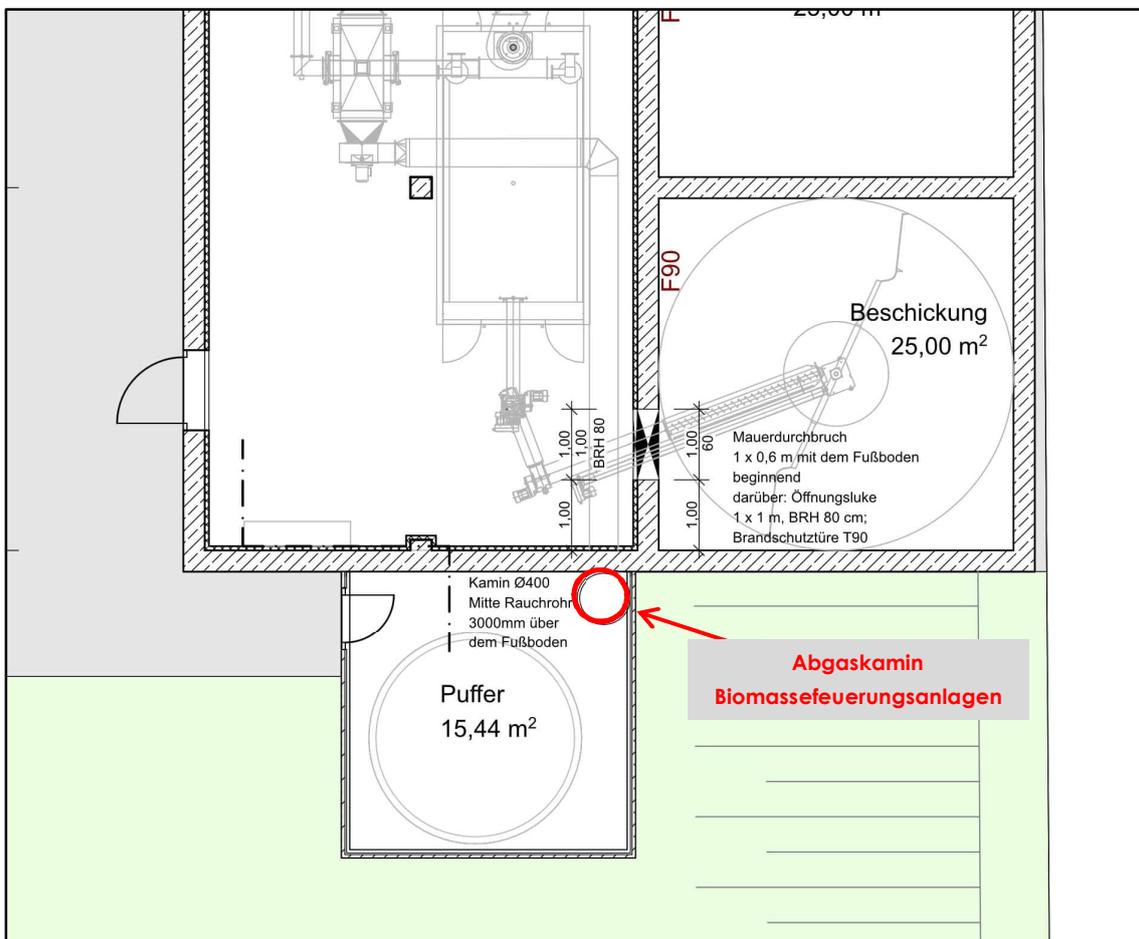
Lageplan mit Kennzeichnung der Emissionsquelle
